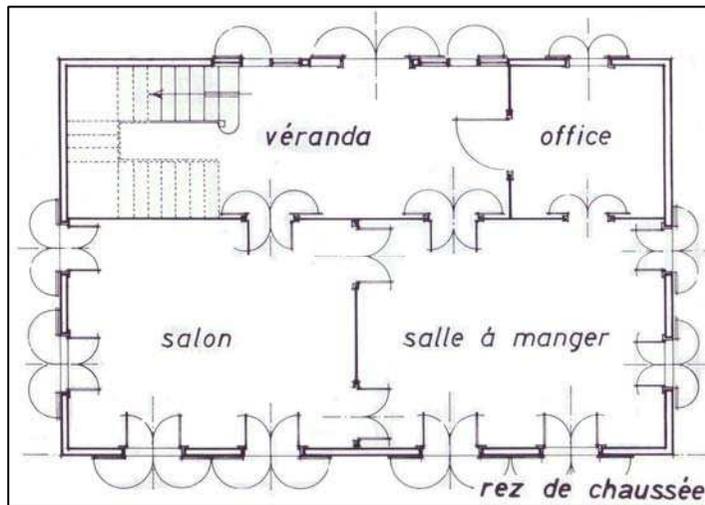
Plan du rez-de-chaussée d'une maison traditionnelle
